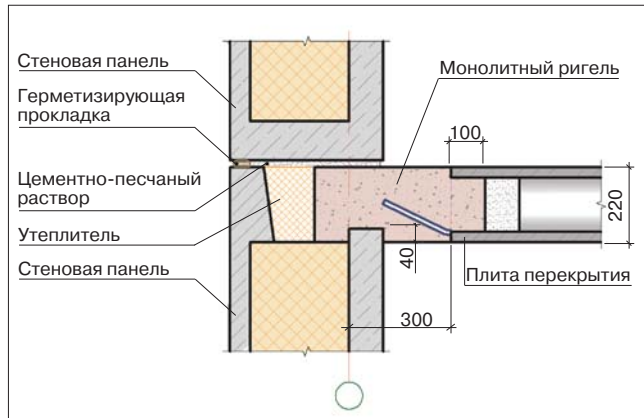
Конструктивное решение формирования бетонного «зуба» при бетонировании монолитного ригеля
